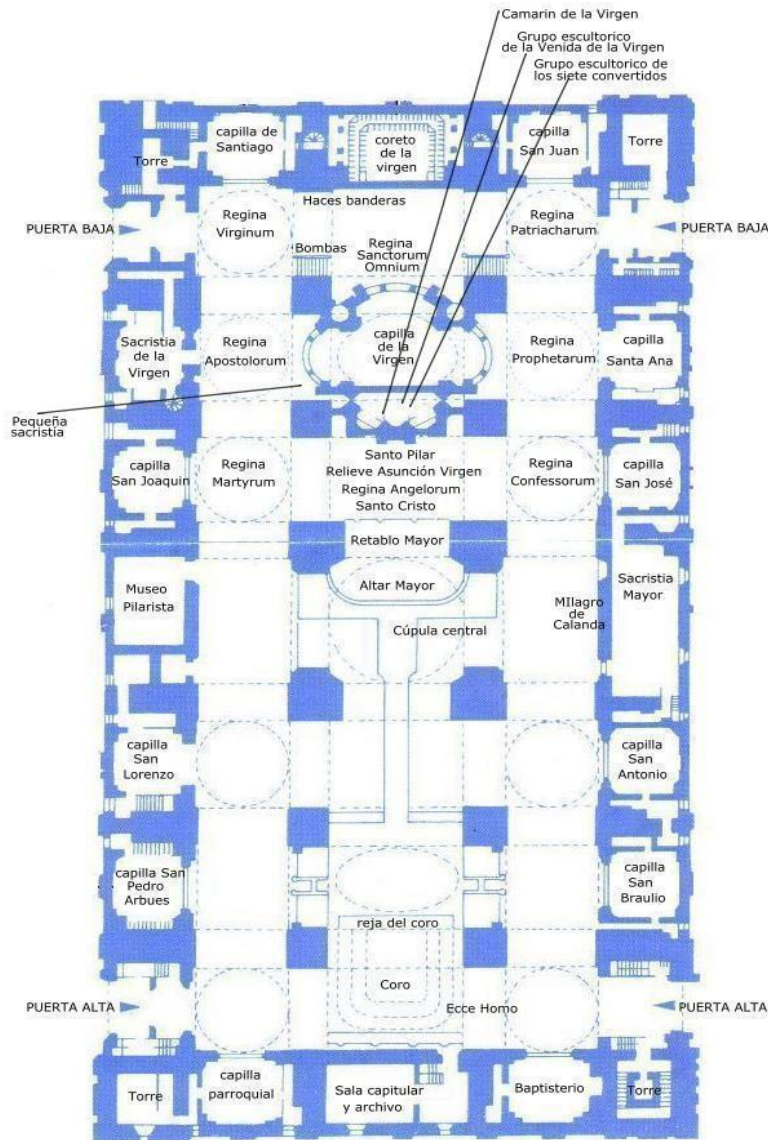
Planta de la Basílica del Pilar. Cúpulas decoradas.
